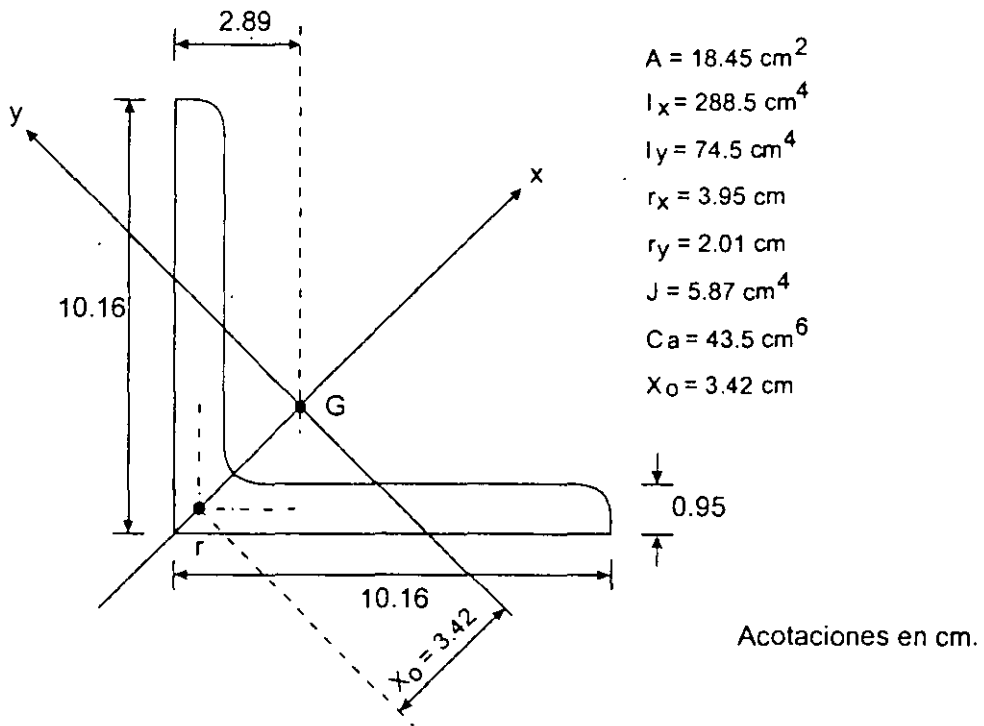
Sección transversal y propiedades geométricas de la columna del ejemplo 2.6.
